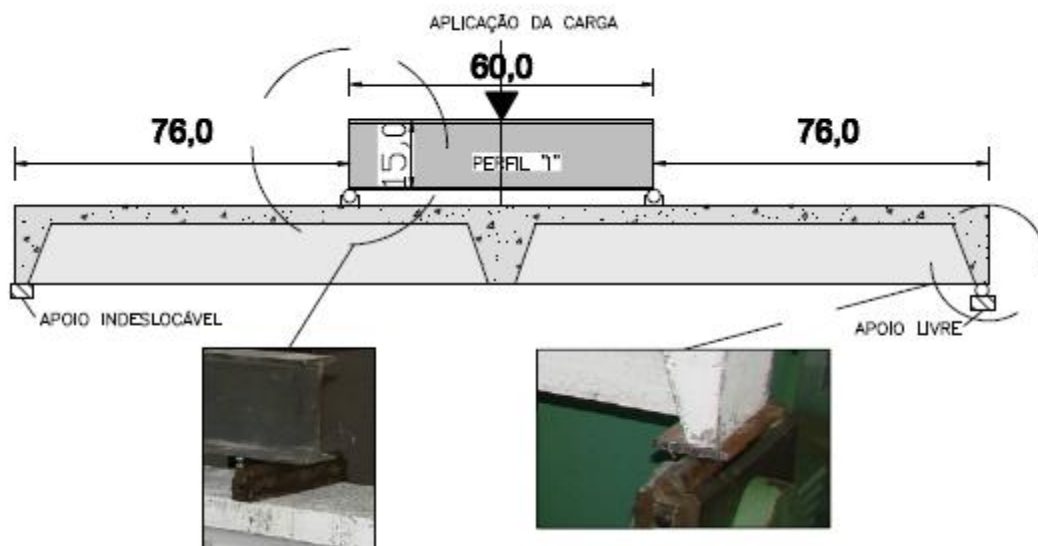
Detalhes da aplicação de carga e apoios das Vigas.
